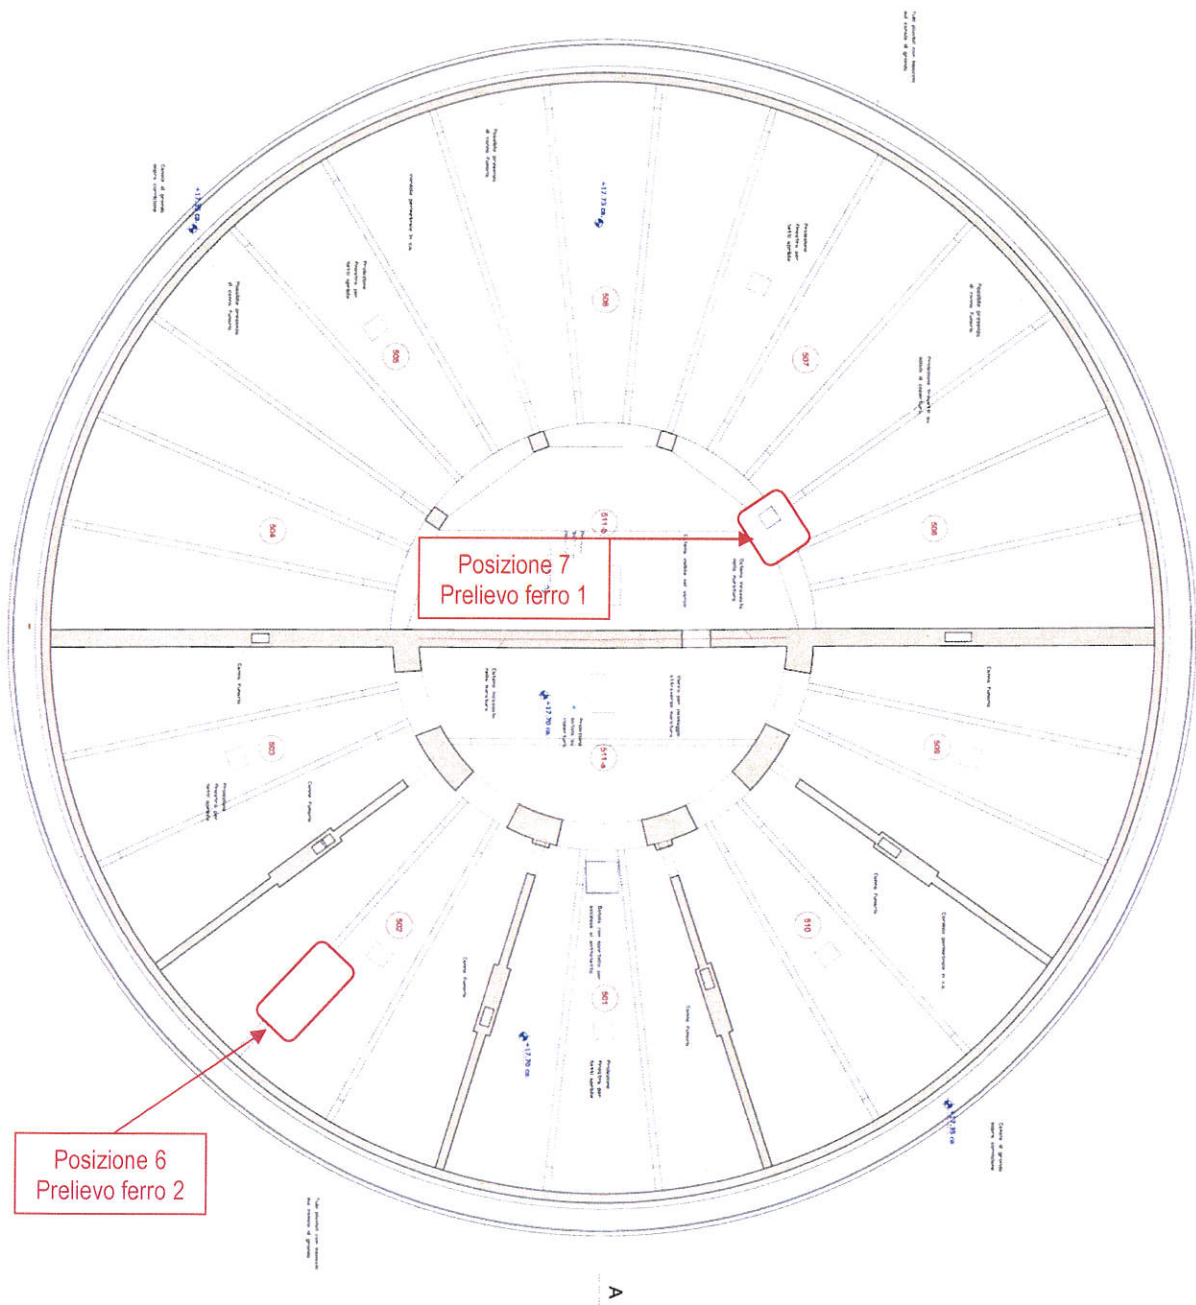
Sottotetto - posizione delle prove e dei prelievi delle barre di armatura
